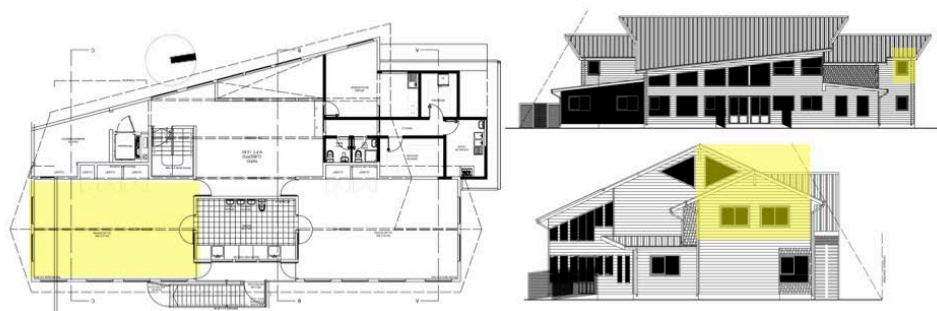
Planta de Arquitectura NIVEL 2 / Elevación Poniente y Sur. FUENTE: Planimetría JUNJI.
